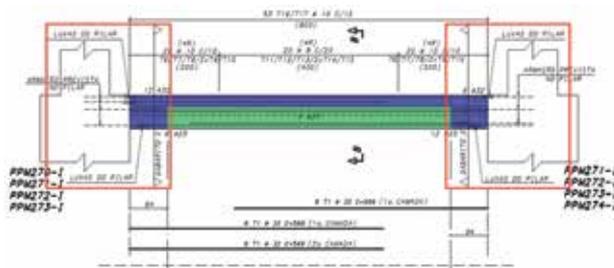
Detalhe da especificação das luvas na elevação da armação de uma das vigas do subsolo.
